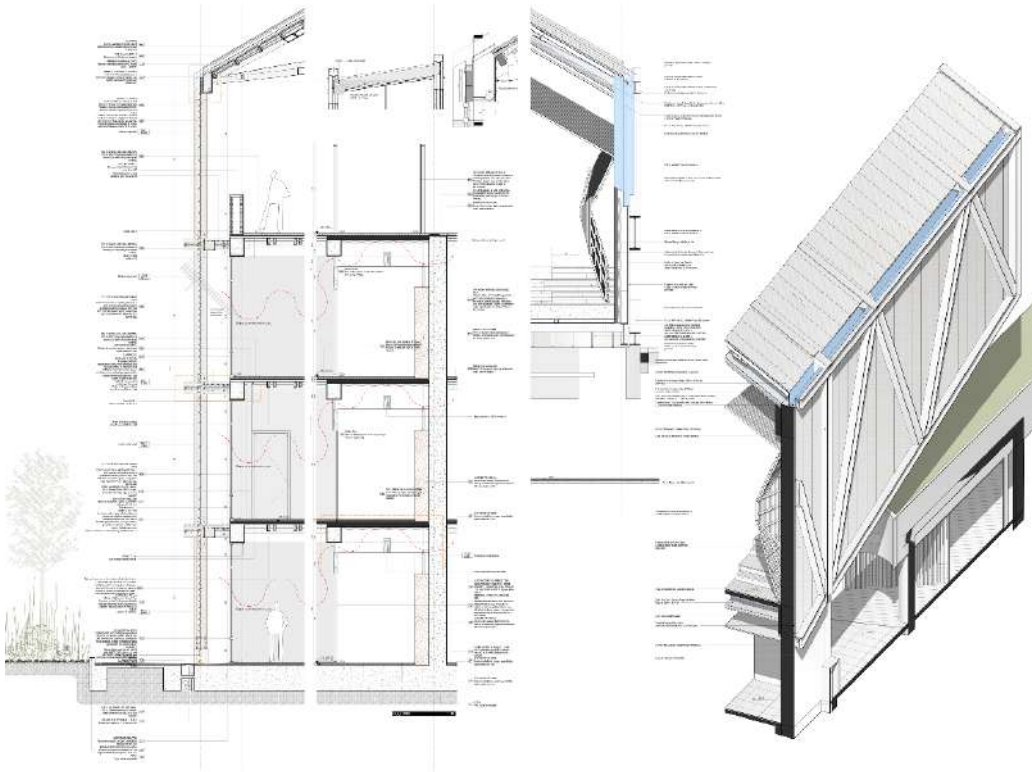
| Sezione e assonometria della facciata. (Studio TAB, 2018).
